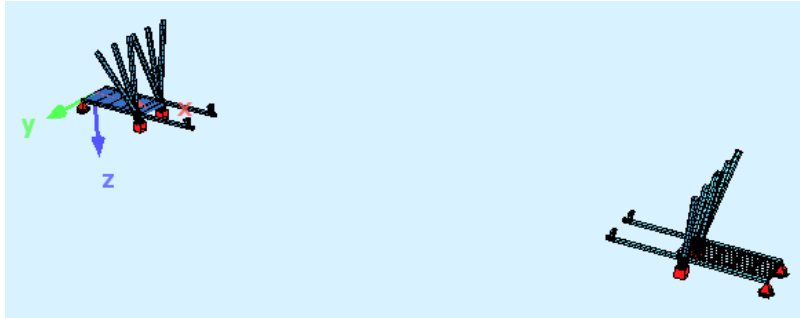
Montaż dźwigarów sekcji 0-1 – przypadek LC20
